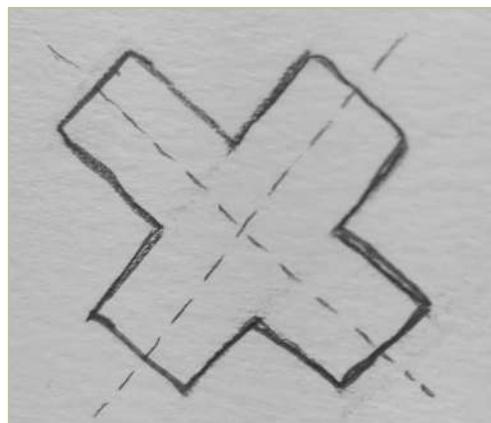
Conceptualización. Retomando la figura de la “Cruz de la Salud” ya sea para planta arquitectónica o en la fachada.
